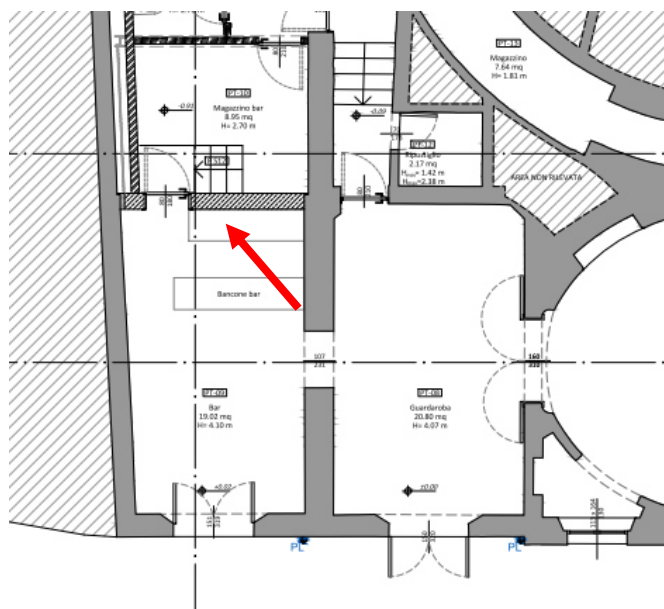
Pianta piano terra con indicazione del muro tra bar e magazzino
